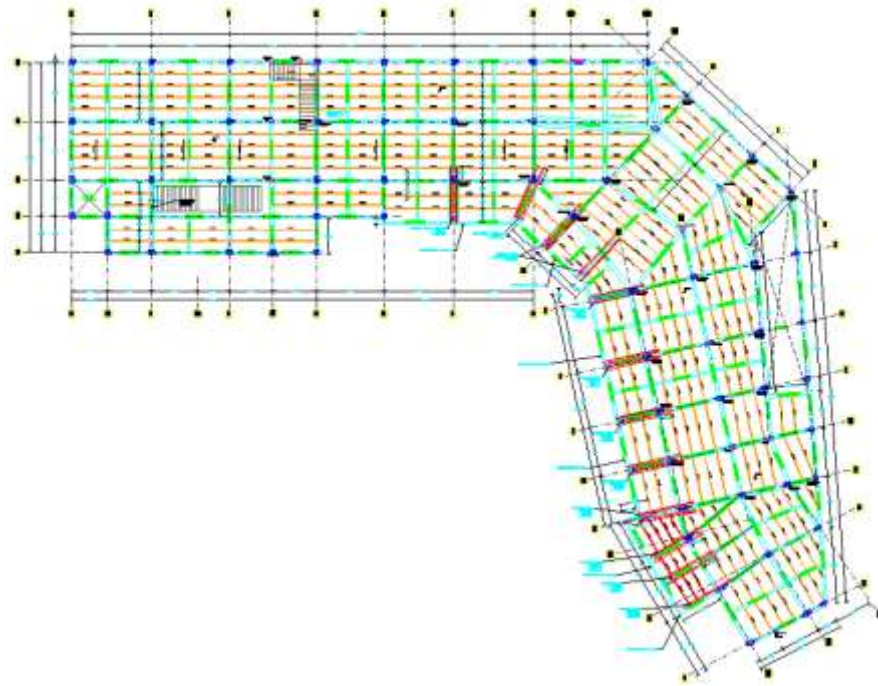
Plano estructural de entrepiso de la losa Metaldeck en el programa AutoCAD.
